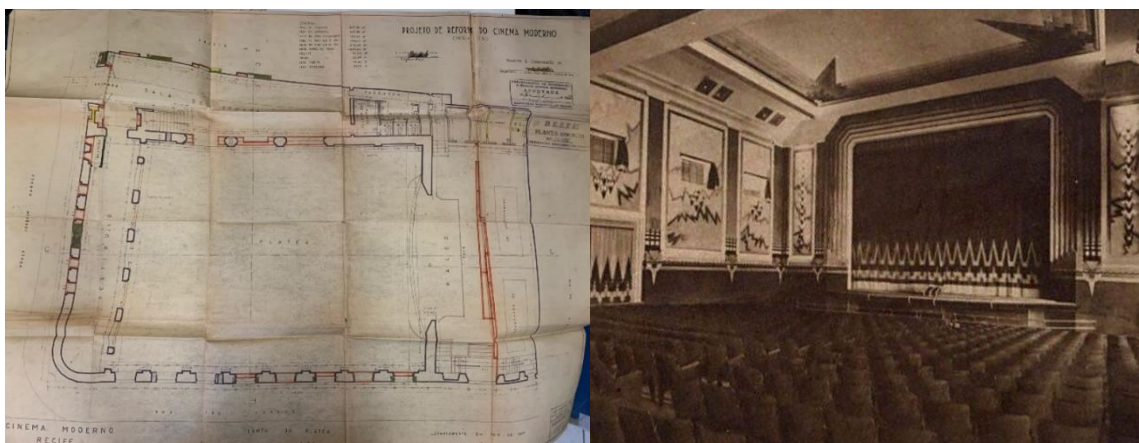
Planta Baixa do Térreo de 1953 e Fotografia interna da área de Plateia após a reforma de Palumbo.
